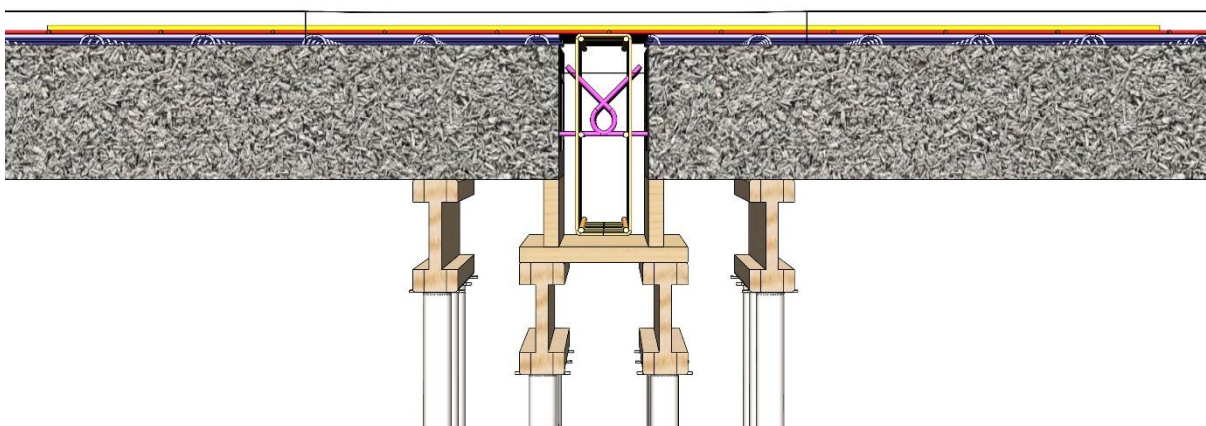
Bande noyée ou poutre voile avec retombée
